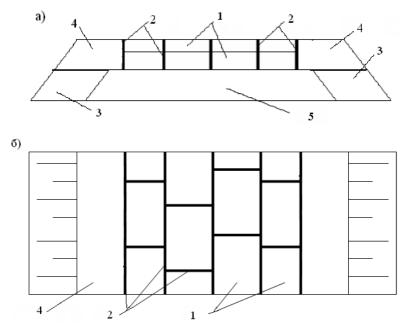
Дорожная одежда из плиты сборного покрытия из асфальтобетона, армированной не менее чем двумя слоями полимерной арматуры:
